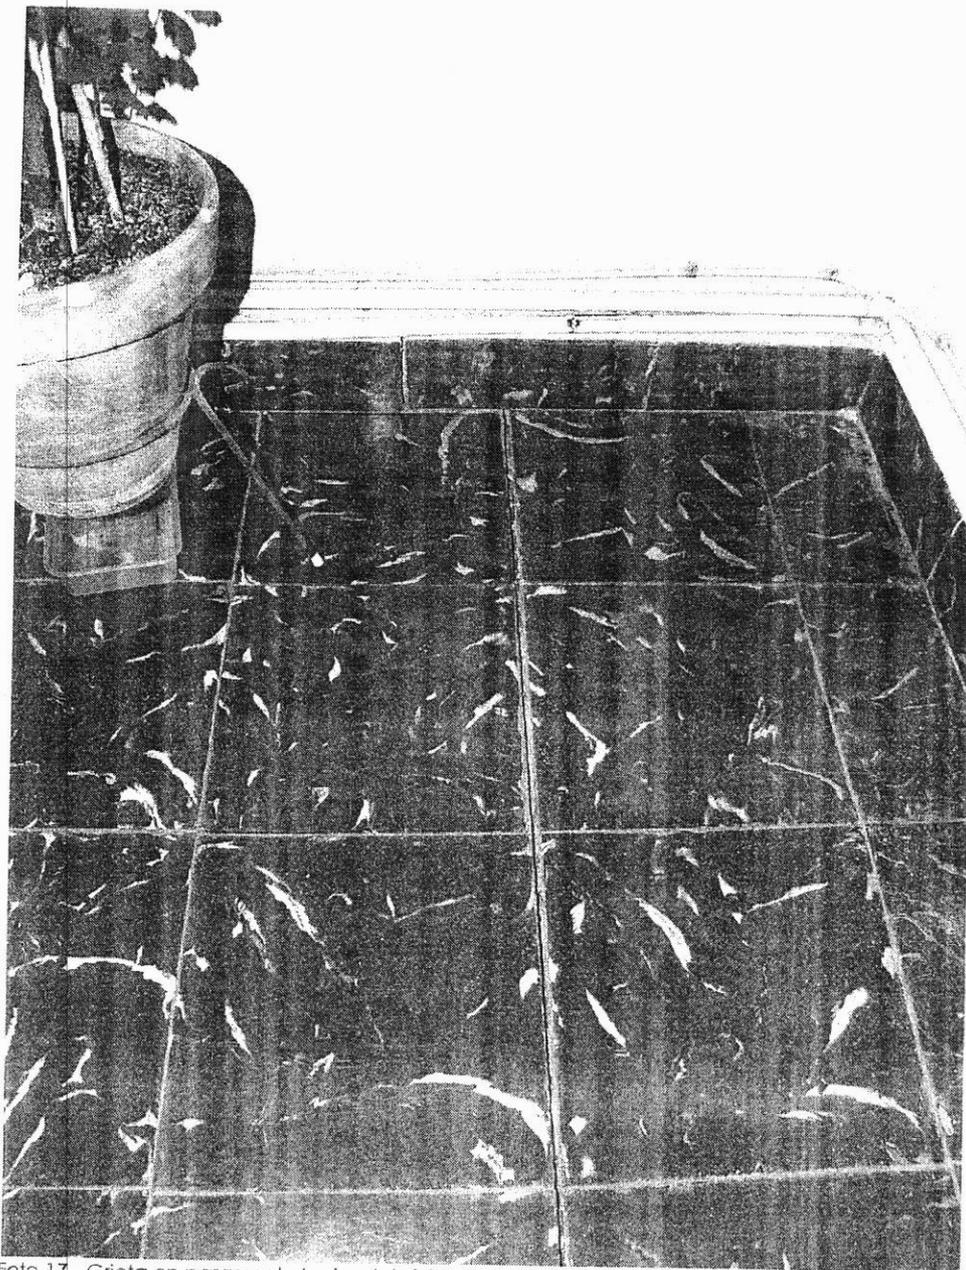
Grieta en paramento horizontal vivienda 9
